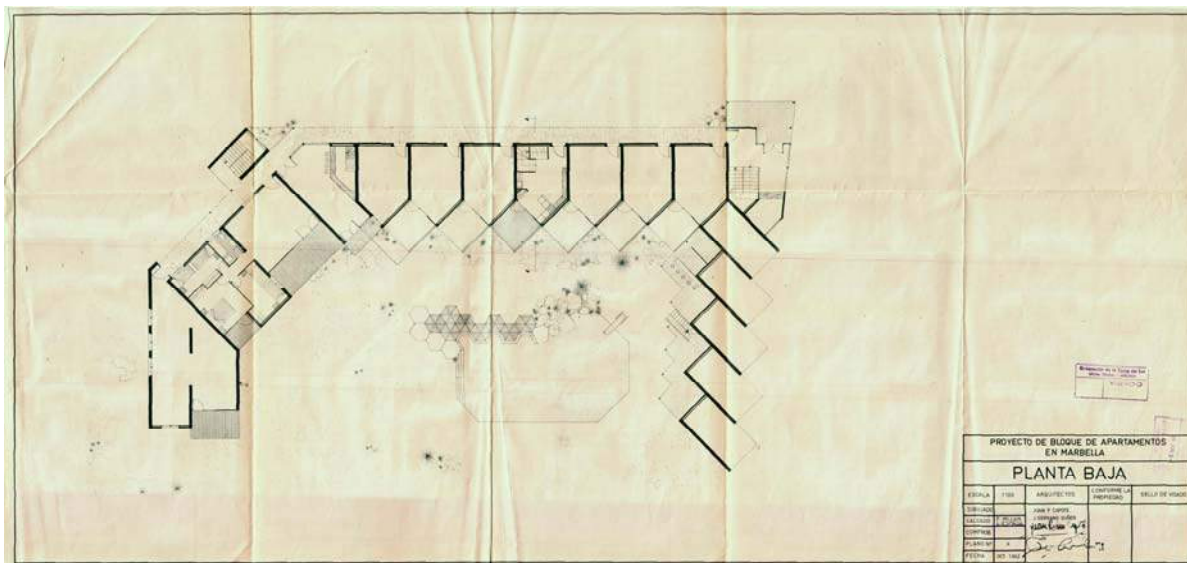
Edificio Avenida. Planta Baja, (Archivo Histórico de Marbella)
